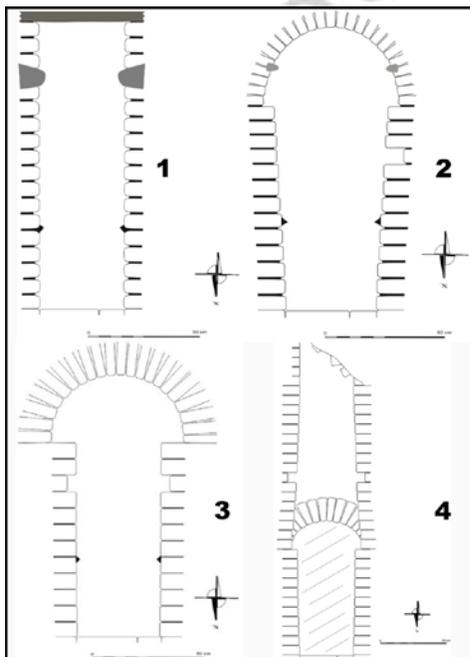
Secciones realizadas en la galería sur hasta la primera *spiramina
